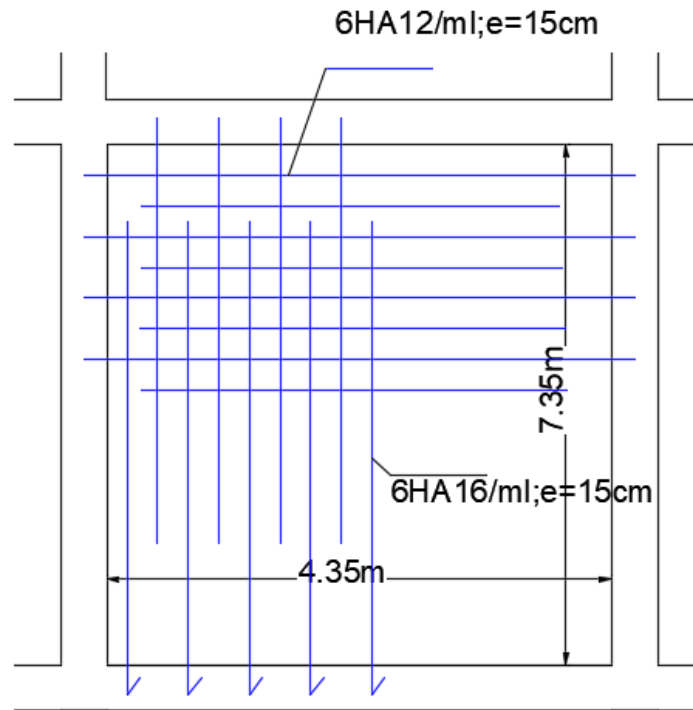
Schéma de ferrailage de la dalle du radier pour 1ml.
